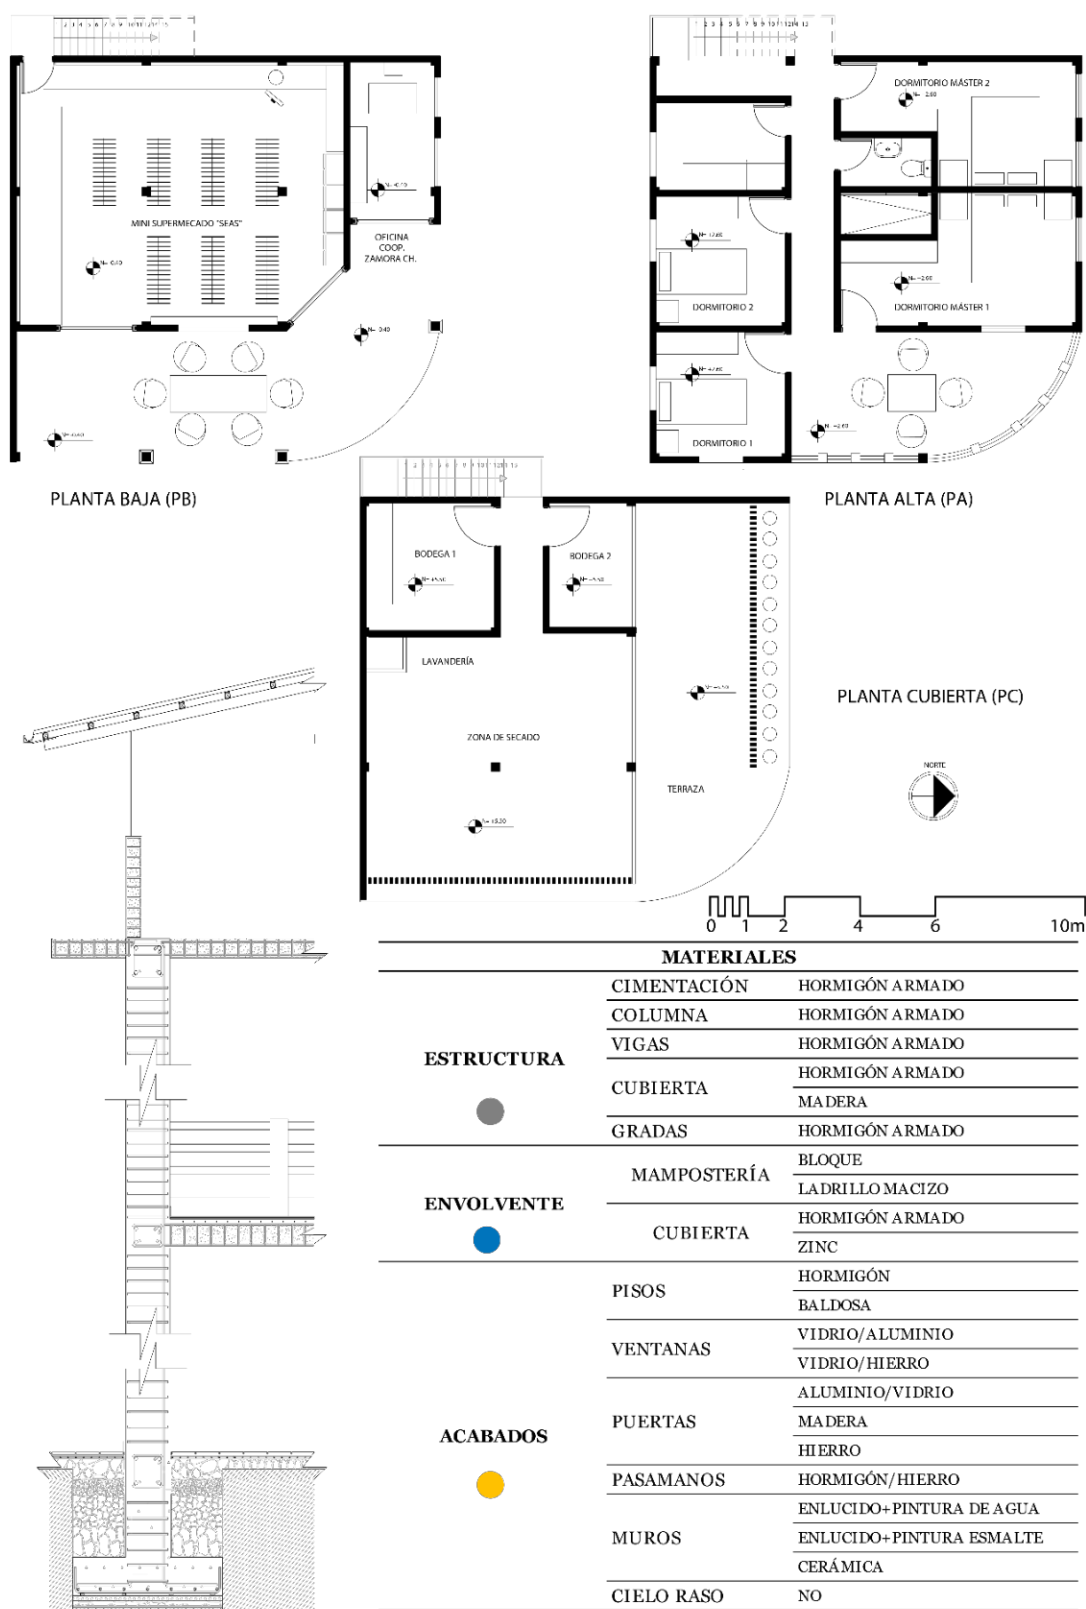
a) Planos de planta baja. b) Planos de planta alta. c) Sección constructiva. Fuente: Elaboración propia.
